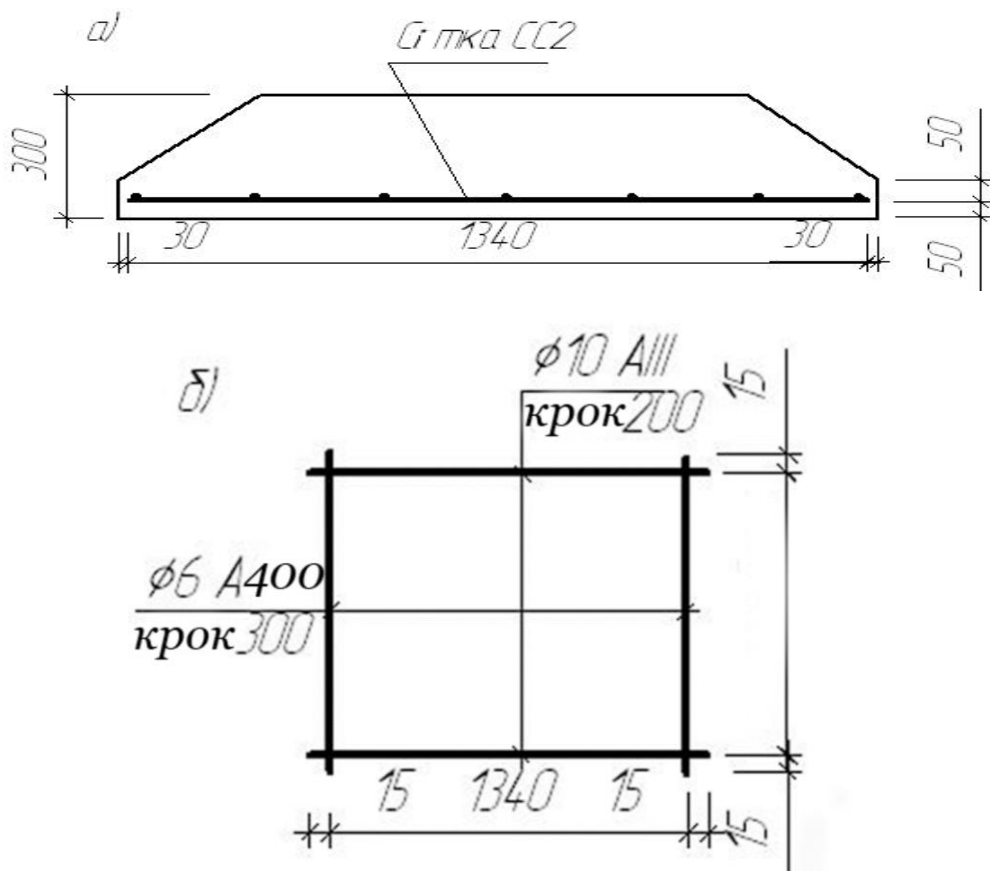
Фундаментна плита під внутрішню стіну.
